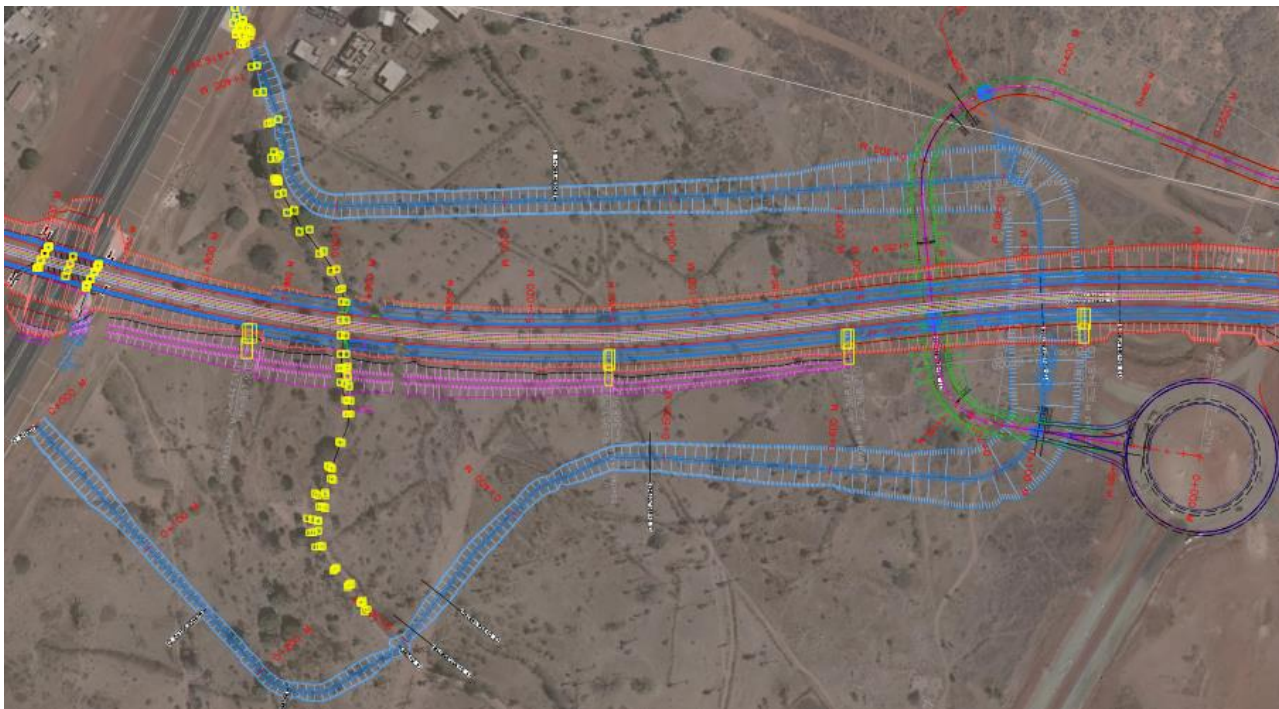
Extrait de la vue en plan/profil en long du Schéma de l'Ouvrage Hydraulique de Traversée
